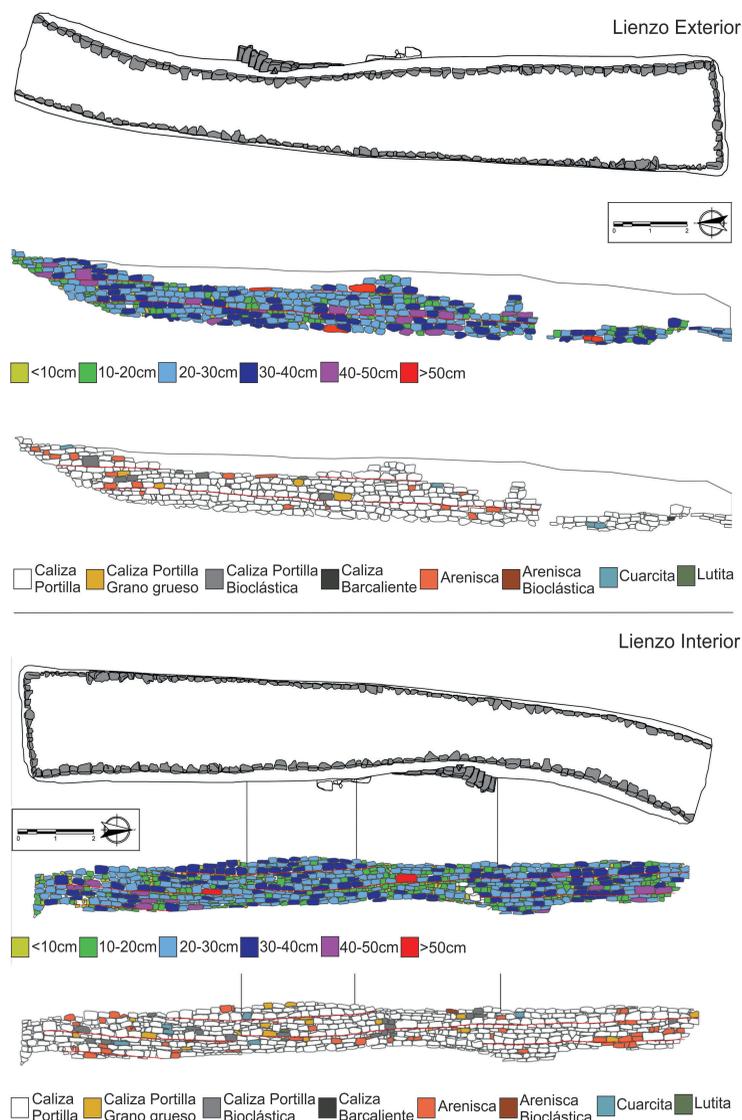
Planimetría de la muralla (Cara exterior e interior) con los diferentes módulos de piedra y materias primas usadas.
